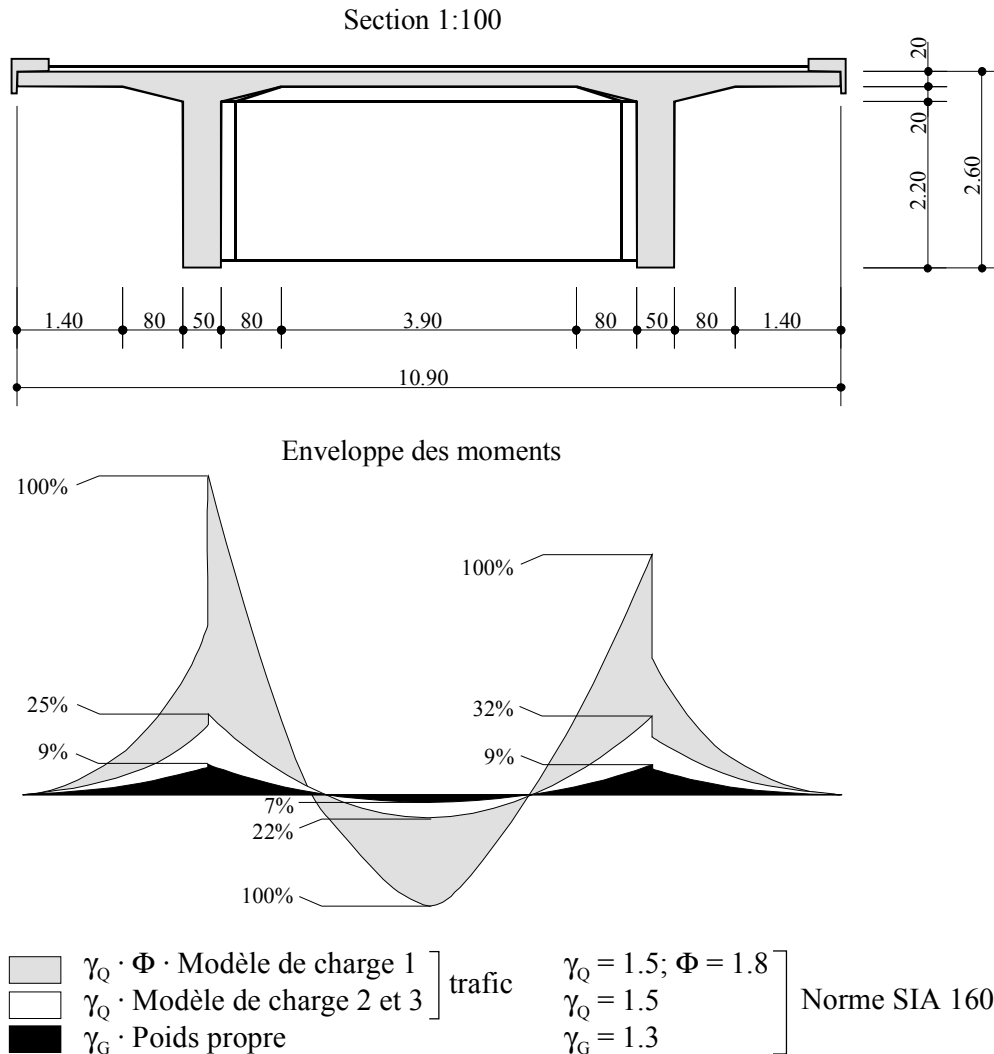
Enveloppe des moments transversaux dans la dalle d'un pont-poutre
